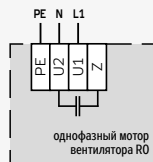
клеммная коробка и конденсатор (одноф. двигатель)
